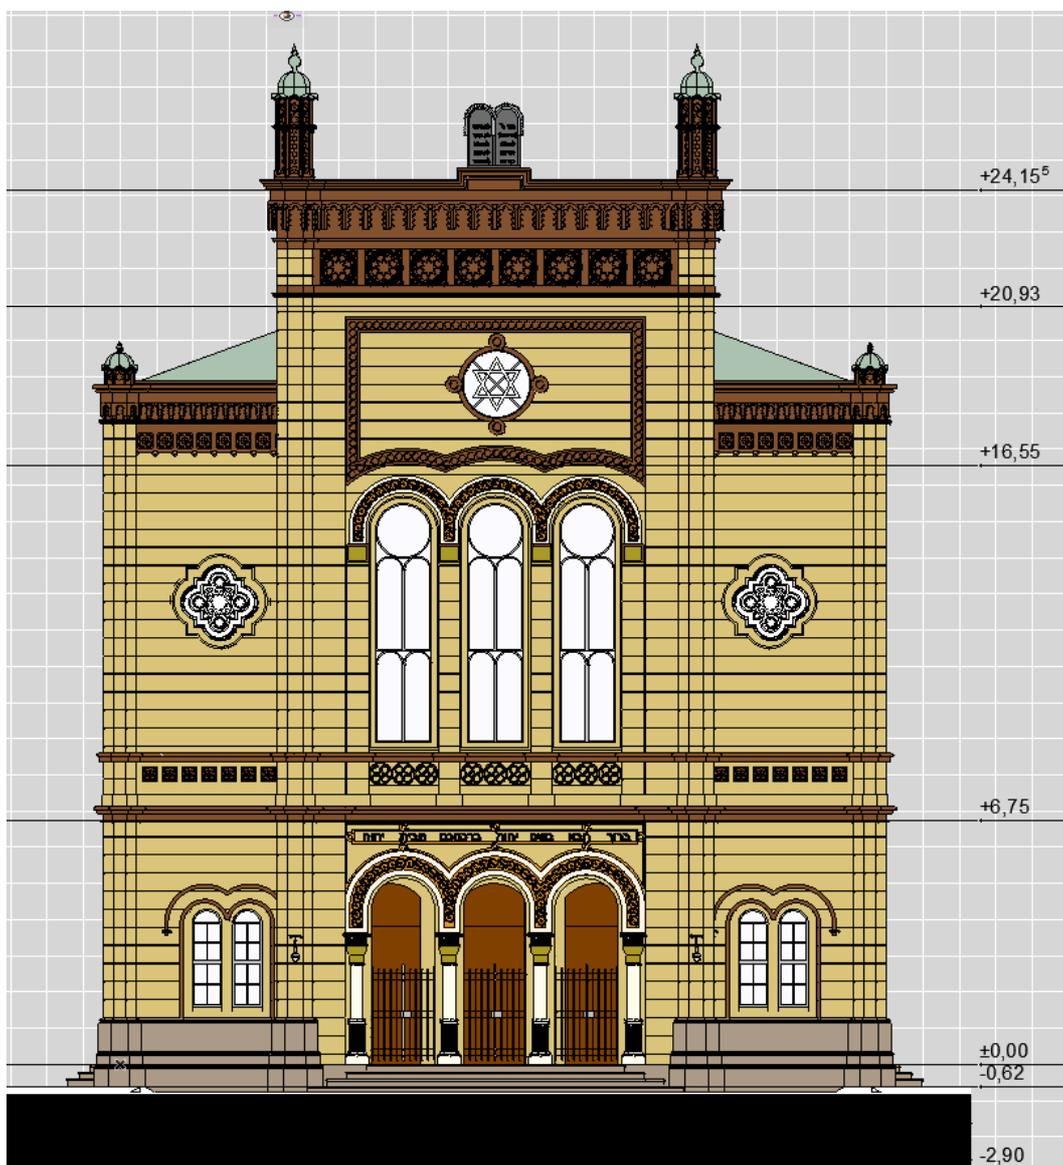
Frontfassade - Die sieben Niveaus mit den Höhenkoten, Bildschirmaufnahme.
